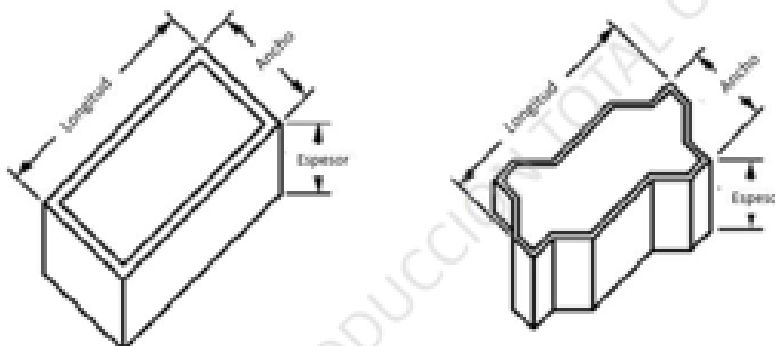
Longitud, ancho y espesor de las unidades de concreto para pavimentos
